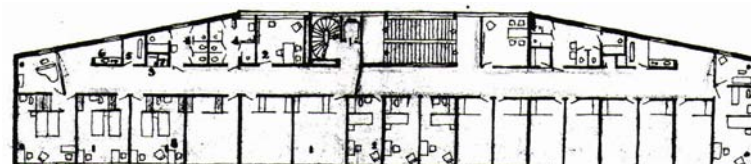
Casa do Brasil, projeto Lúcio Costa. Pavimento térreo.
